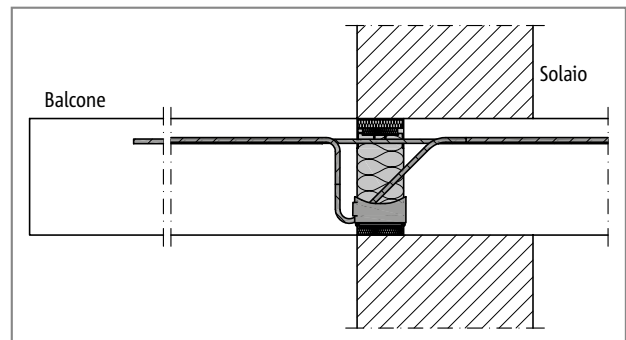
Schöck Isokorb® T tipo KL, raccordo del balcone con muratura monostato isolante
